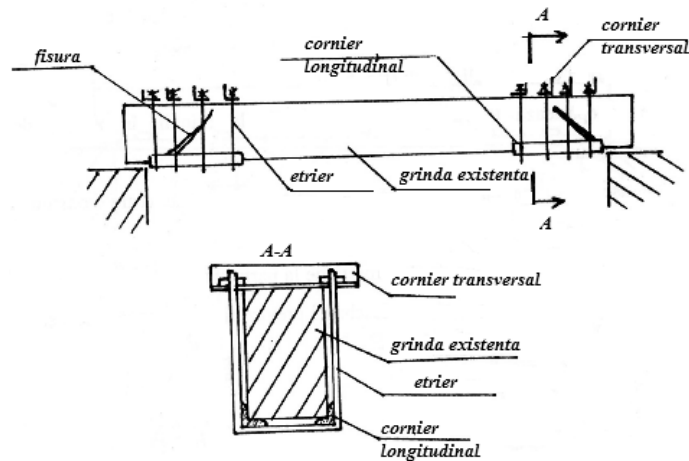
Consolidarea locală a grinzilor din beton armat cu etrieri [76]
